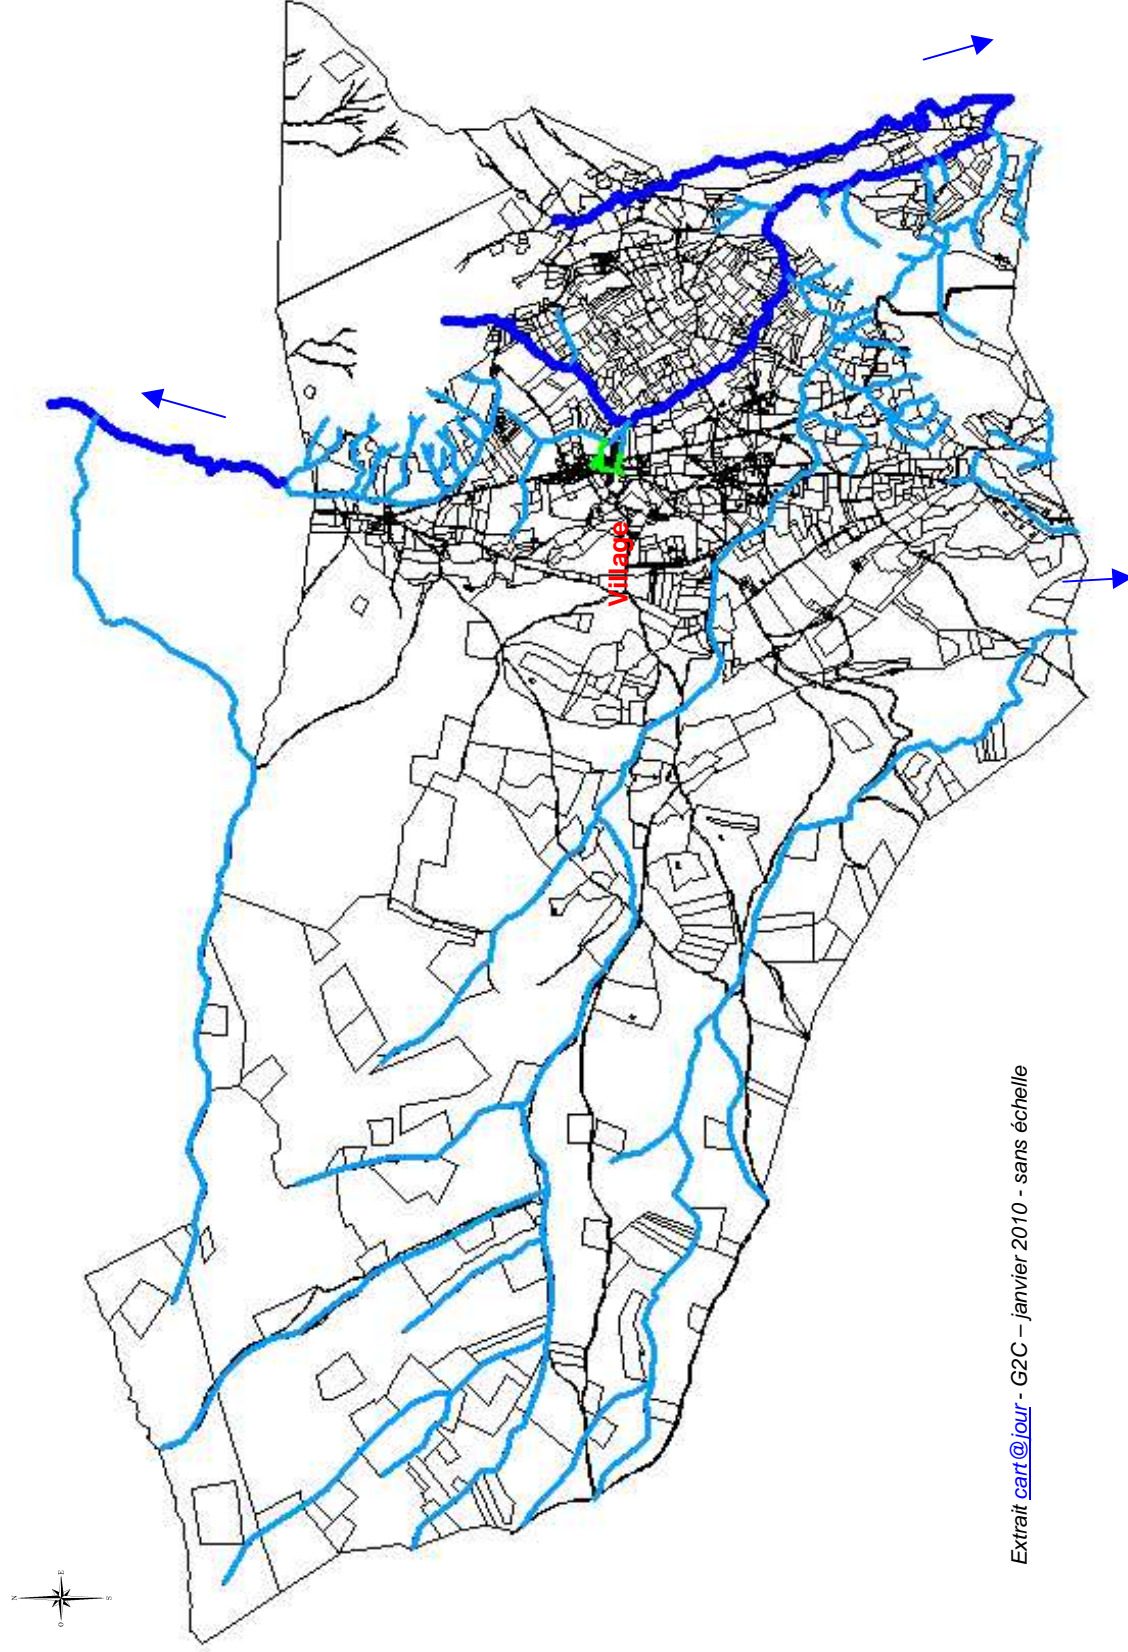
Plan du réseau d'eaux pluviales au niveau du centre village
